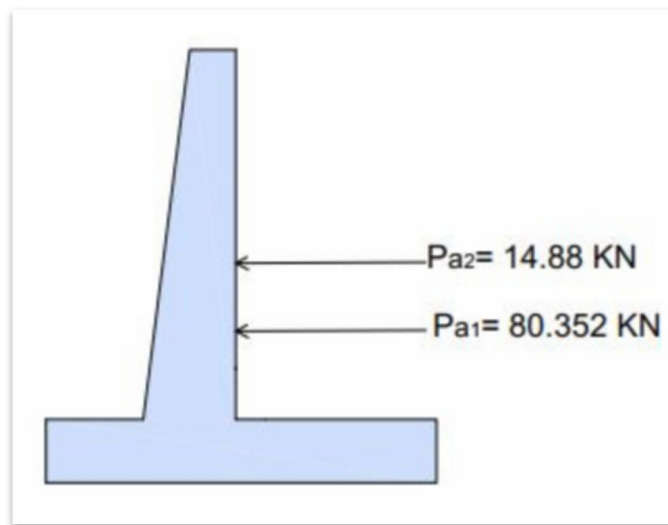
Les forces de poussées statiques du au surcharge et au remblai
